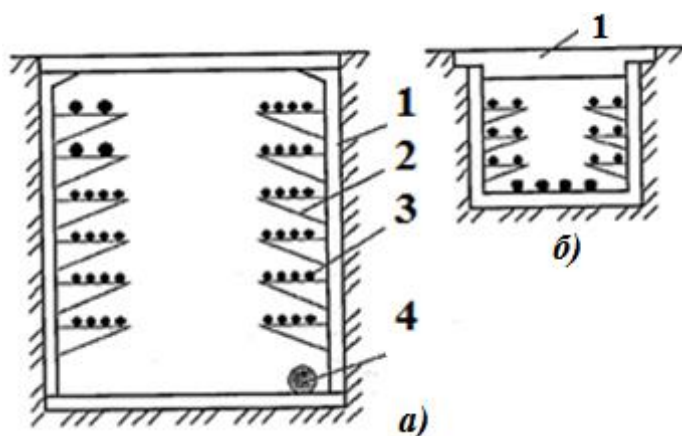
Прокладка кабелей в тоннеле (а) и канале (б): 1 – железобетонный тоннель; 2 – кронштейн; 3 – кабель; 4 – труба водопроводная
